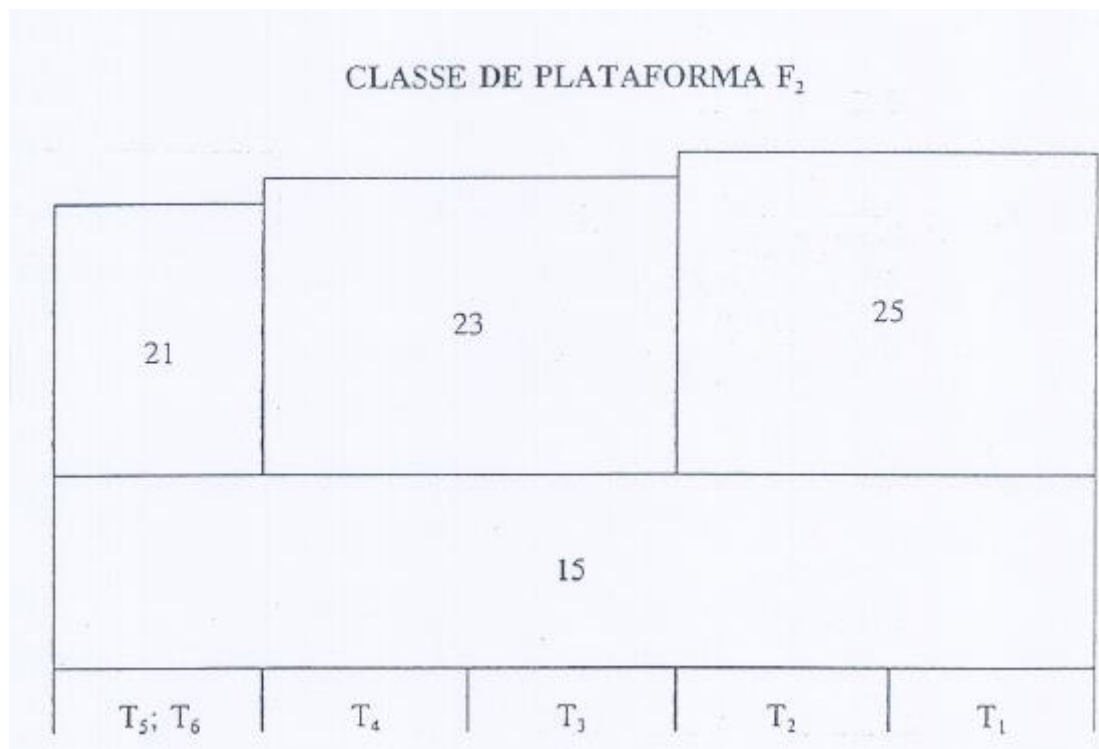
Estruturas de pavimentos para a classe F2 segundo MACOPAV (JAE, 1995)
